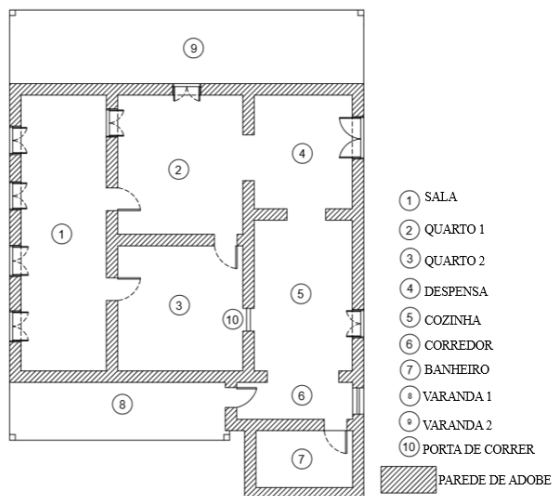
Planta baixa esquemática (crédito: P. Enoré)
